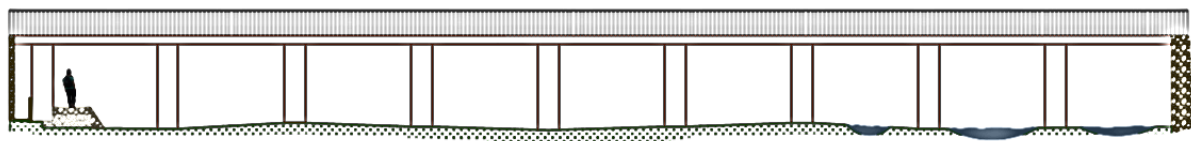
Ejecución de terraplén para rampa bajo puente de San Fernando
